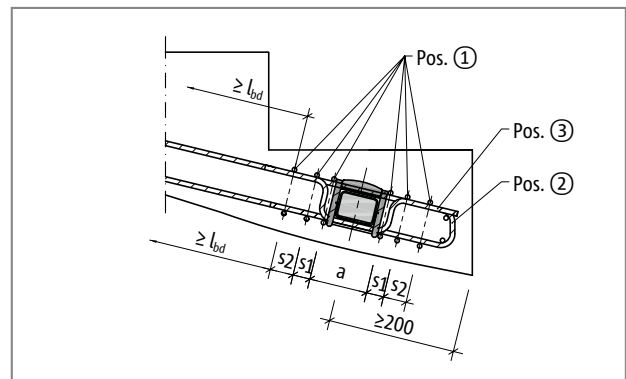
Schöck Tronsole® tipo Q, sezione "punto piede"
